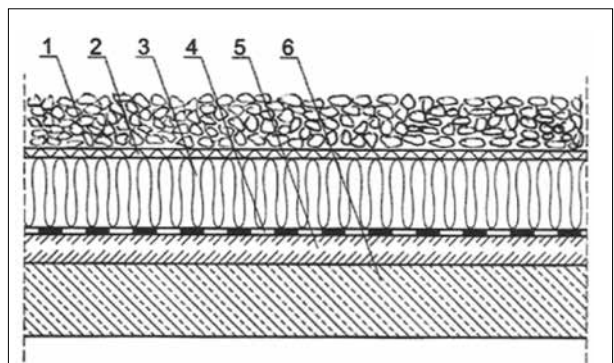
| Stropodach pełny [2]: 1 – konstrukcja nośna, 2 – termoizolacja, 3 – hydroizolacja
